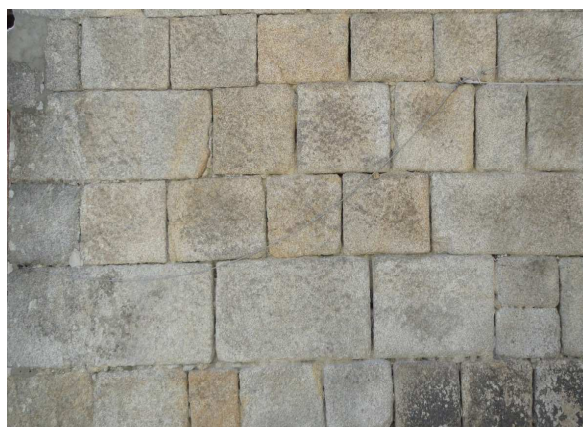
Parede 1 (exterior) do edifício da zona da Muralha Fernandina – MF1.
